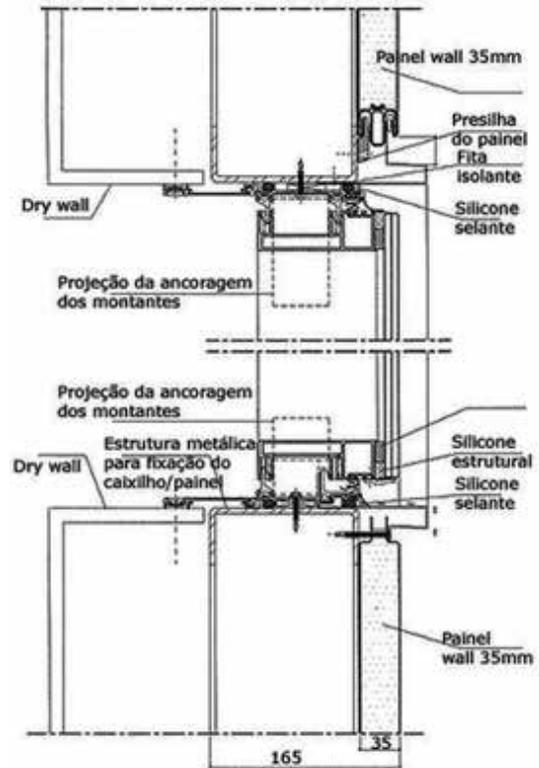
Detalhe em corte de abertura para esquadria em fachada com painel metálico isolante. (FINESTRA, 2004)
